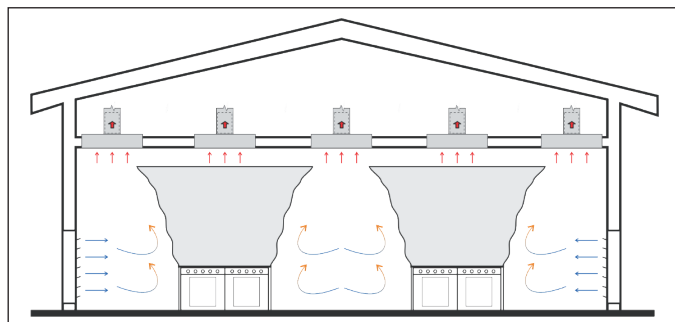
Přívod vzduchu směřováním vířivými anemostaty
